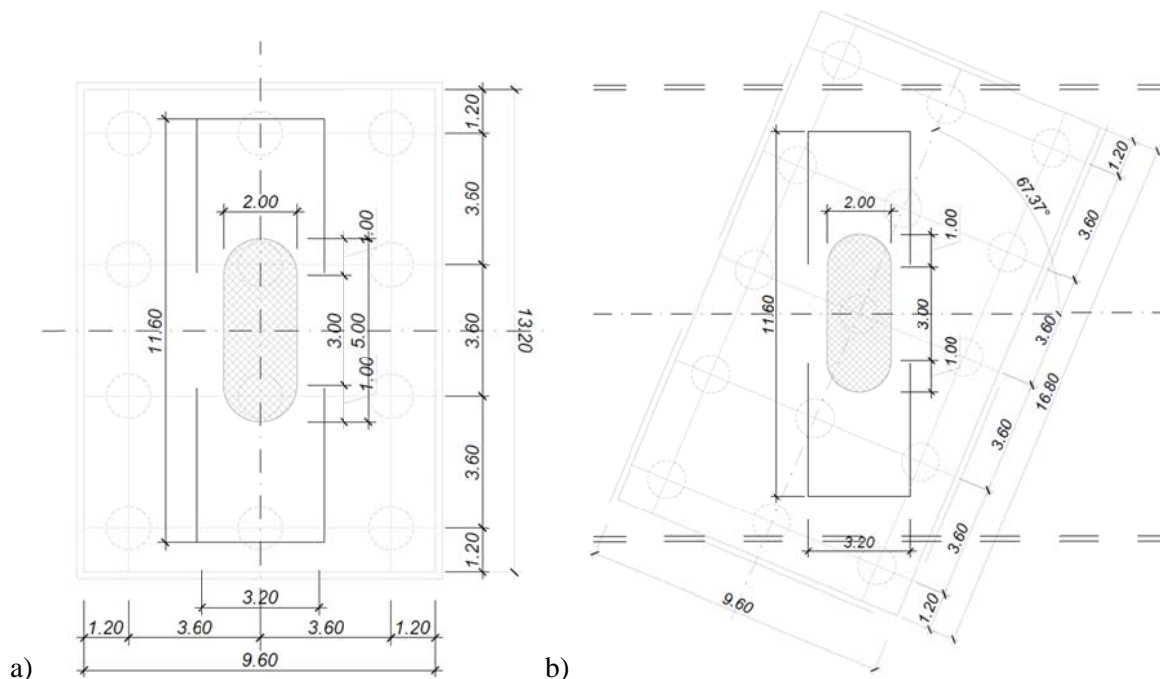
Vista in pianta pila- a) sezione di spiccato pile 1-4 ; b) sezione di spiccato pile 2-3
